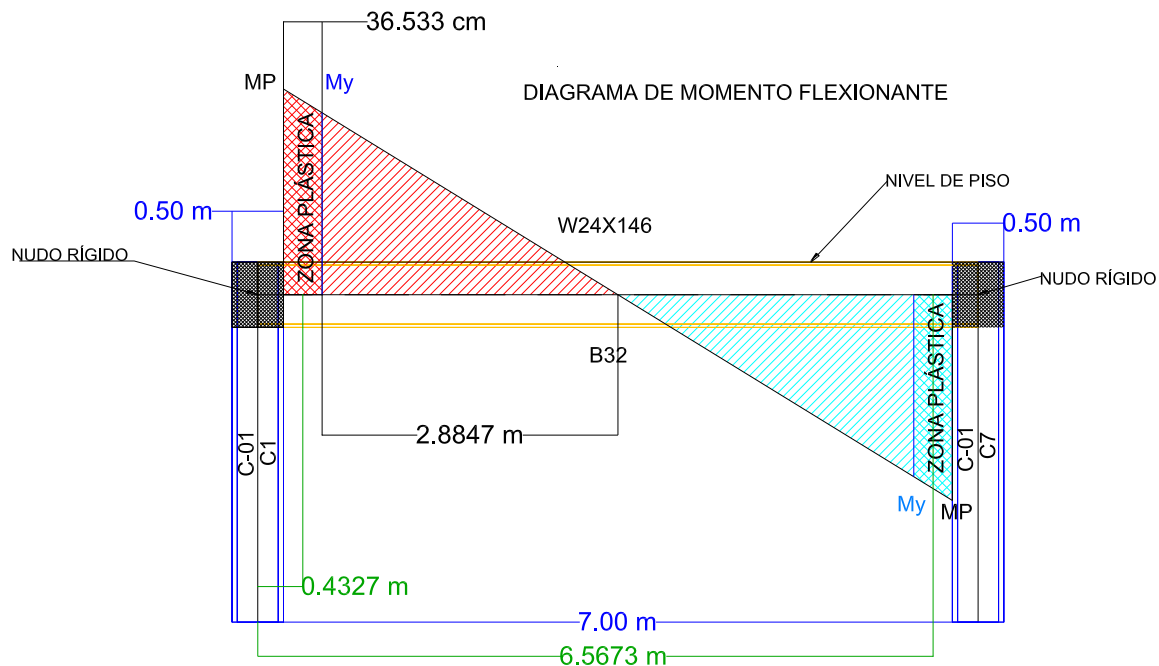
Ubicación del centroide de las zonas plásticas en vigas
